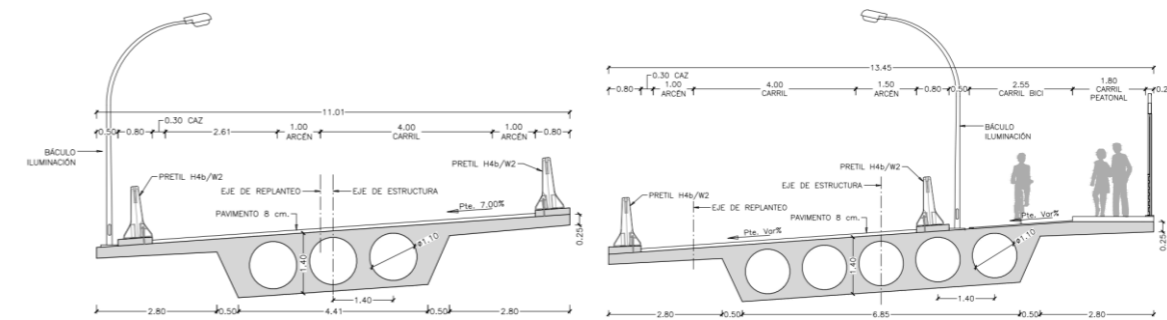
Estructura E-9. Sección tipo por eje 17 y eje 20
